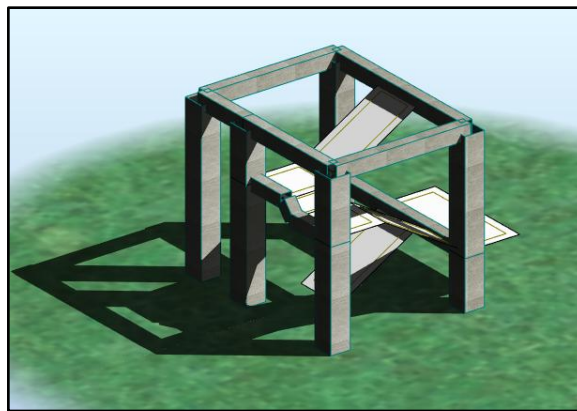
Vue en 3D de l'escalier du rez-de-chaussée (RDC).
